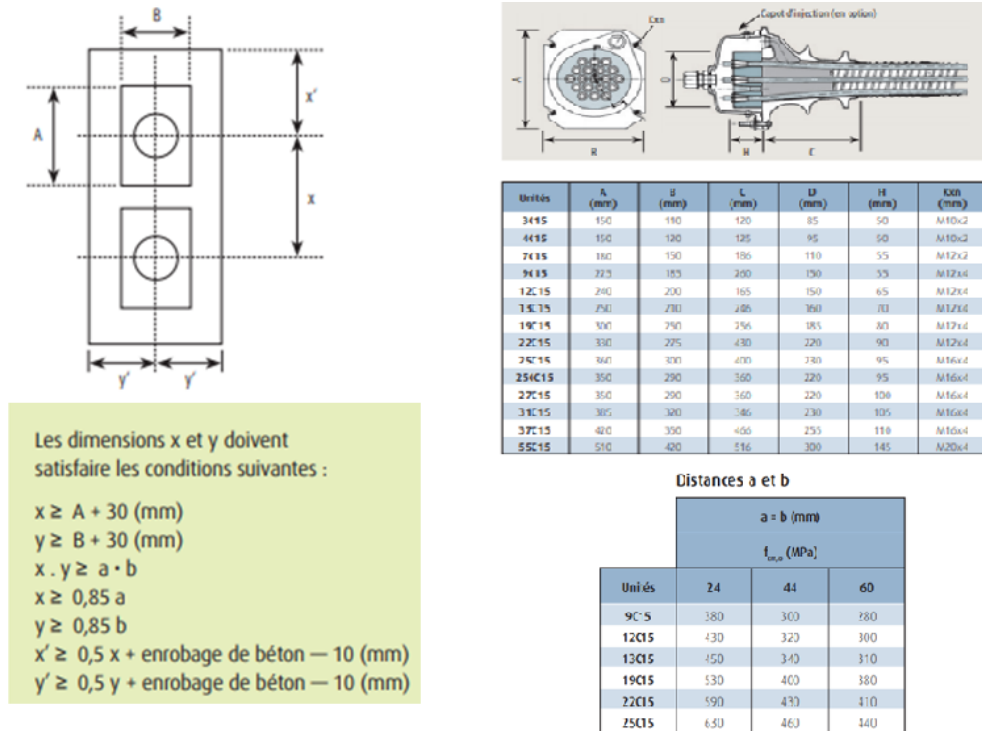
Dimensions et dispositions des plaques d’ancrage
